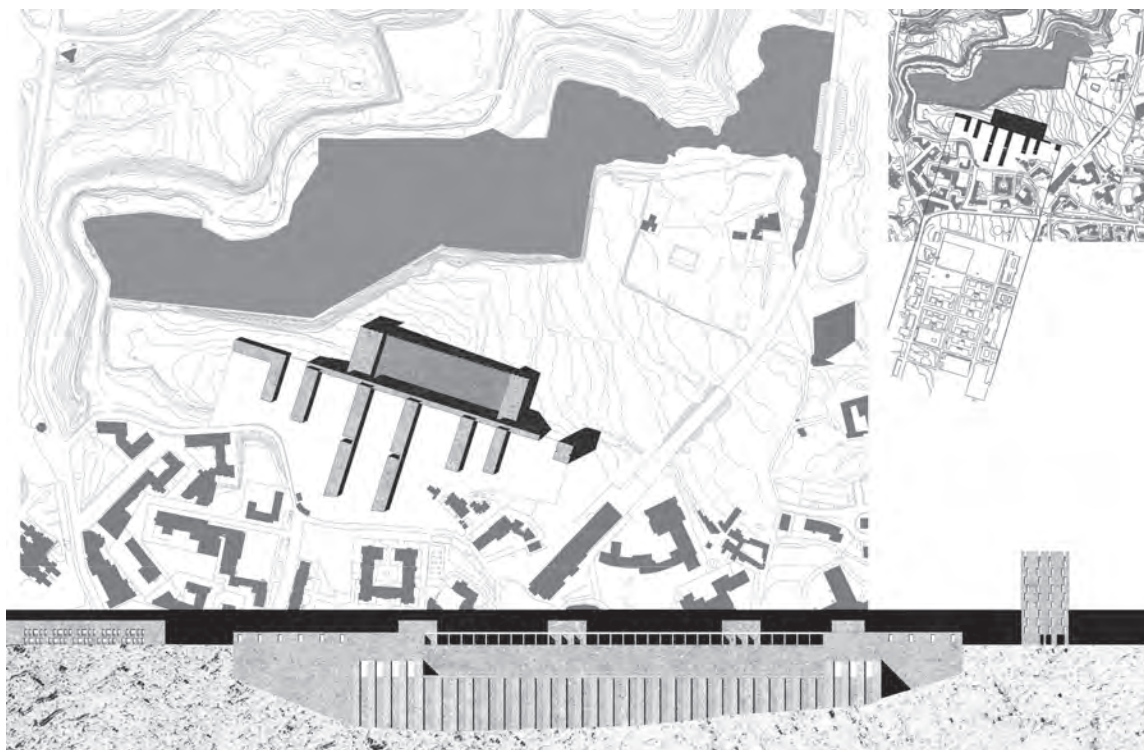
Progetto “Il muro nella campagna”, planivolumetrico, planimetria generale con l’indicazione dell’ingombro del complesso ospedaliero Cardarelli, prospetto verso valle
